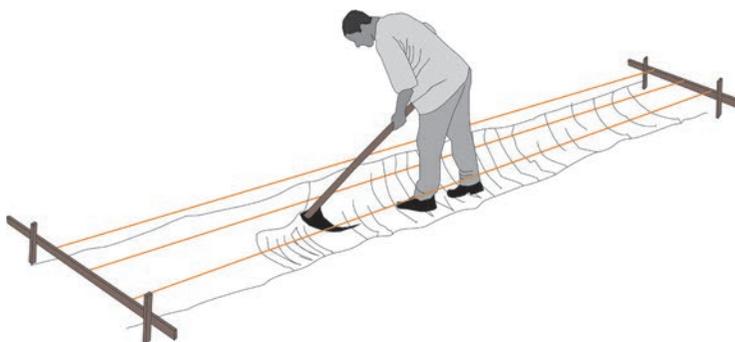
Preparação da área que servirá de fôrma com leve curvatura, onde serão concretadas as placas.
